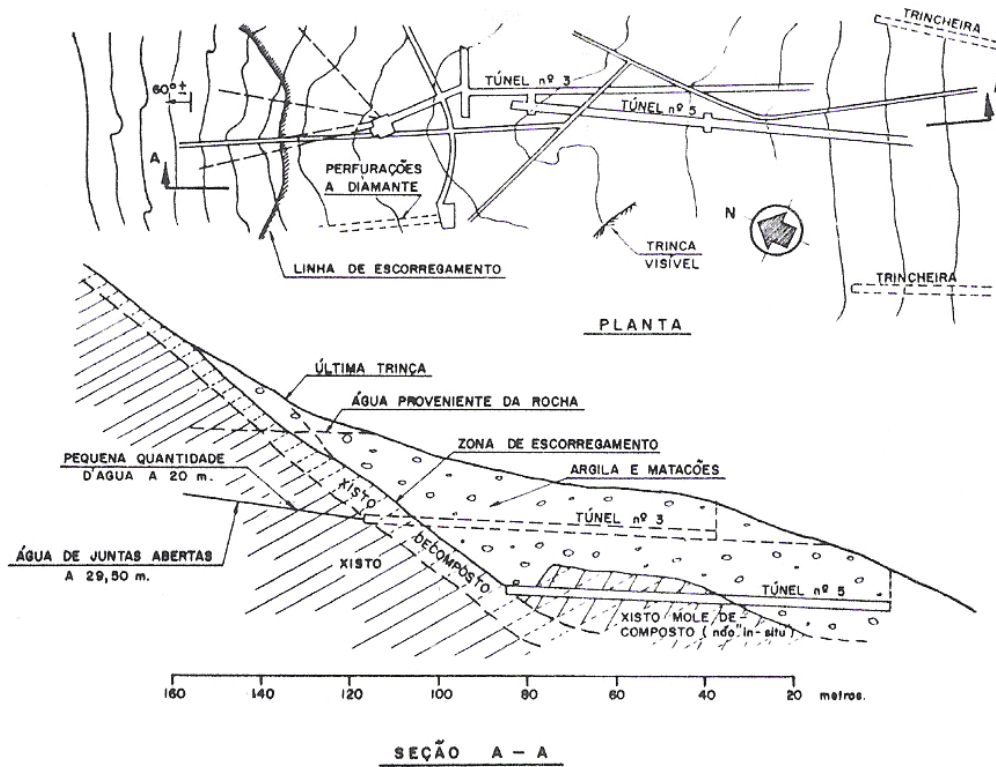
Planta e seção longitudinal do escorregamento da Usina Henry Borden, em Cubatão (Vargas, 1966).
